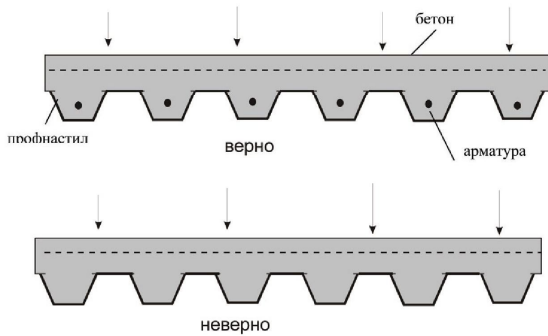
Сечение перекрытия с несъемной опалубкой из профнастила
